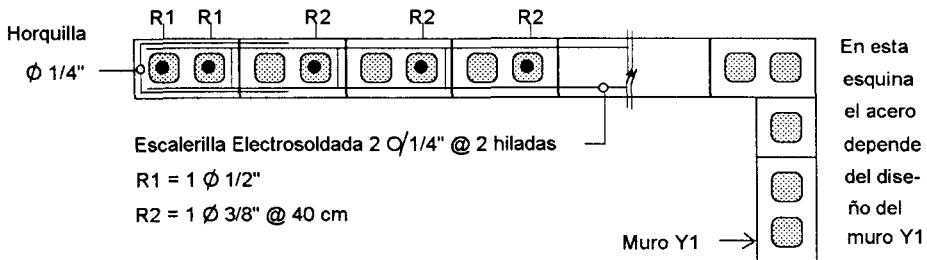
Muro X4 con bloques de concreto vibrado. Ver además las Figs. 2.22 y 2.23
